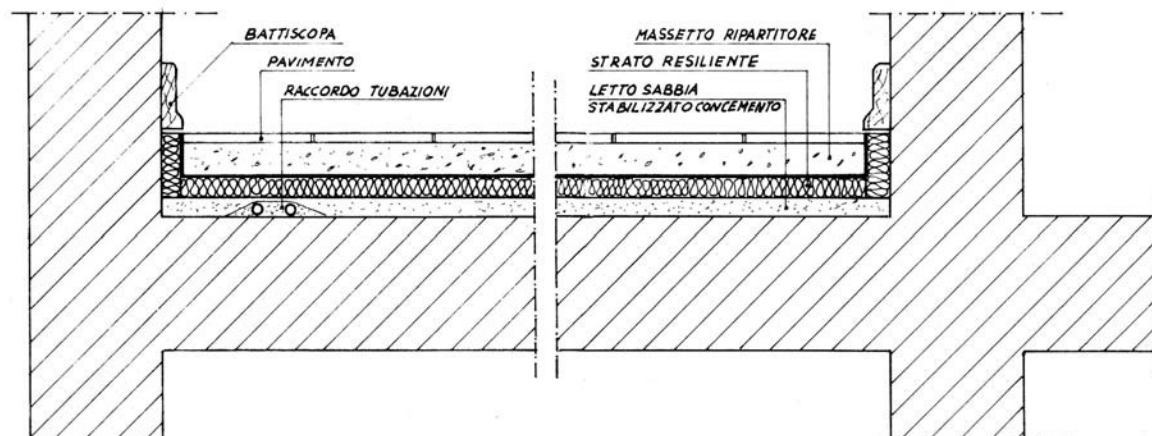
Schema esemplificativo di pavimento galleggiante.
